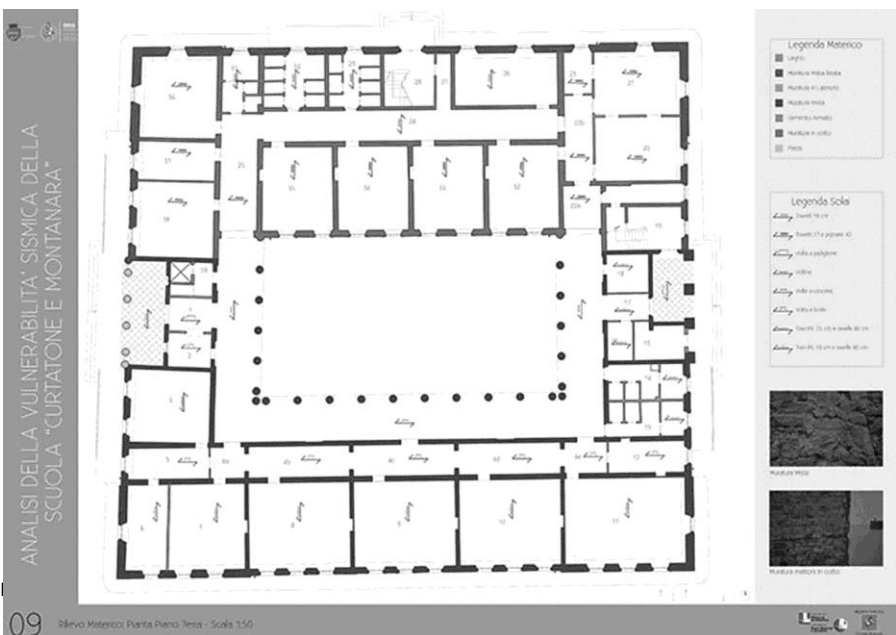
, Pianta piano terra, individuazione delle tecniche costruttive e dei materiali.
